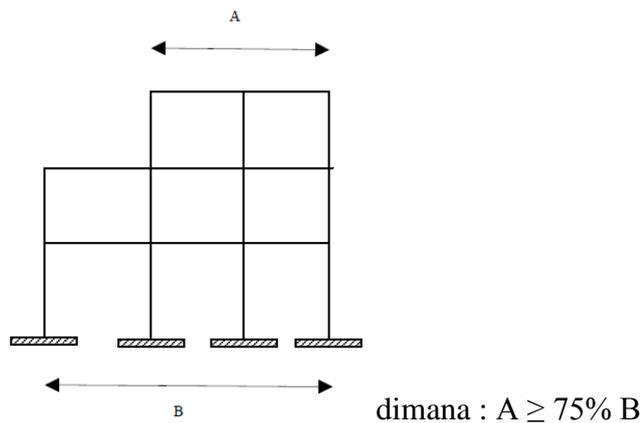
Tonjolan-tonjolan pada Gedung
